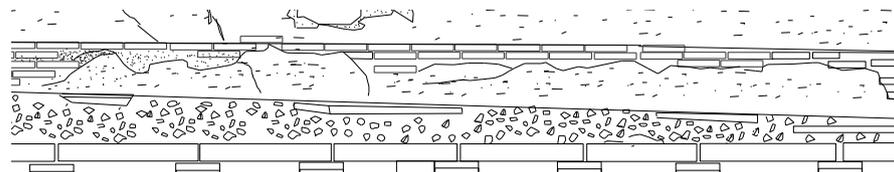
Particolare del prospetto, strati del sistema di *suspensurae*, presso la parete sud dell'ambiente A.
